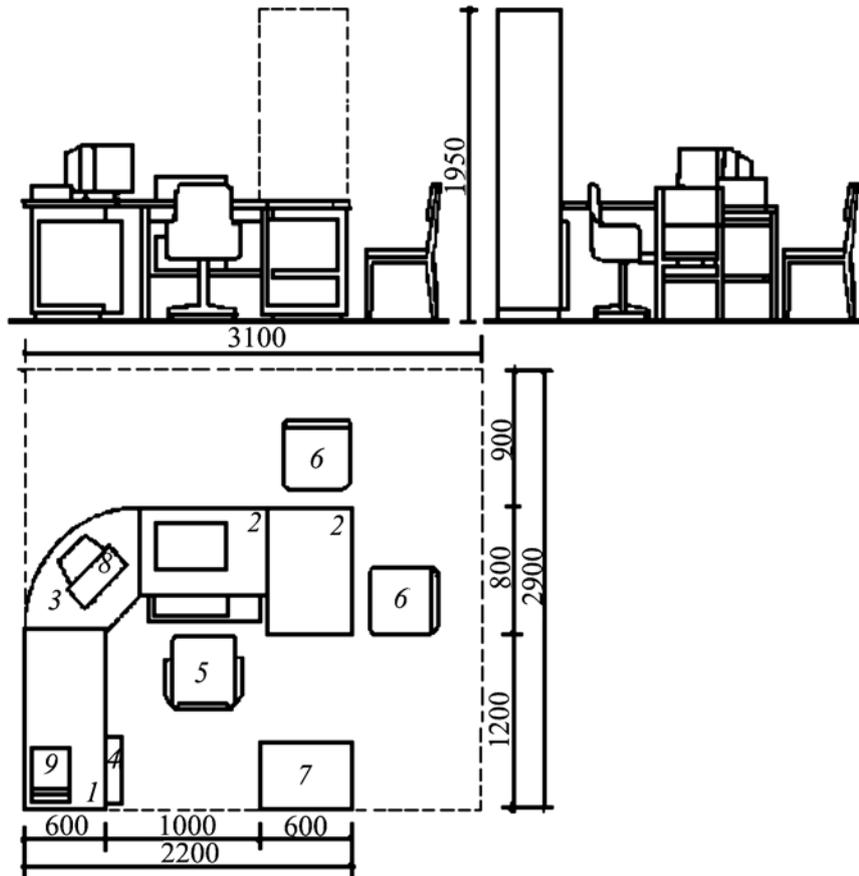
Рабочее место руководителя операционного отдела: 1 — стол рабочий; 2 — стол компьютерный; 3 — стол-вставка; 4 — тумба; 5 — кресло подъемно-поворотное; 6 — стул; 7 — шкаф металлический; 8 — компьютер; 9 — факс
